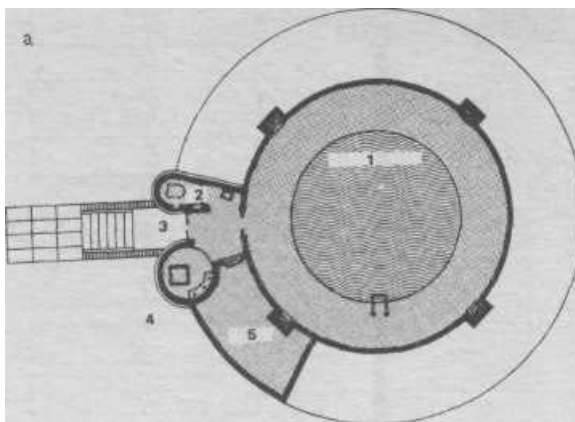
Круглый бассейн, заглубленный в грунт (Хемстед Северный Лондон). Зрительная связь с окружающей средой осуществляется с помощью светового купола из армированного стекла; каркасом купола служат арочные стальные конструкции. Вытяжка воздуха осуществляется вверху купола; мягкий климат местности делает оправданным однослойное остекление. Архитектор Джеймс Гован (Англия)
